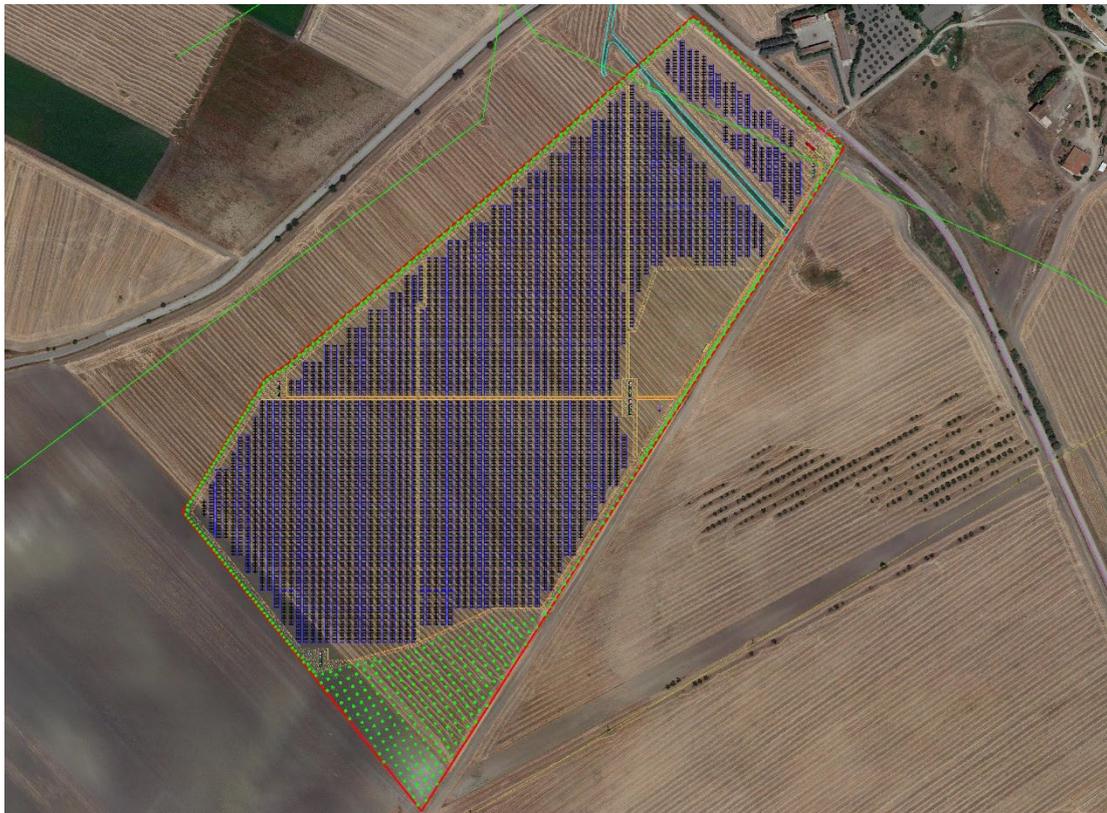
Layout dell'impianto agrivoltaico del "Lotto Bovino" su ortofoto.
